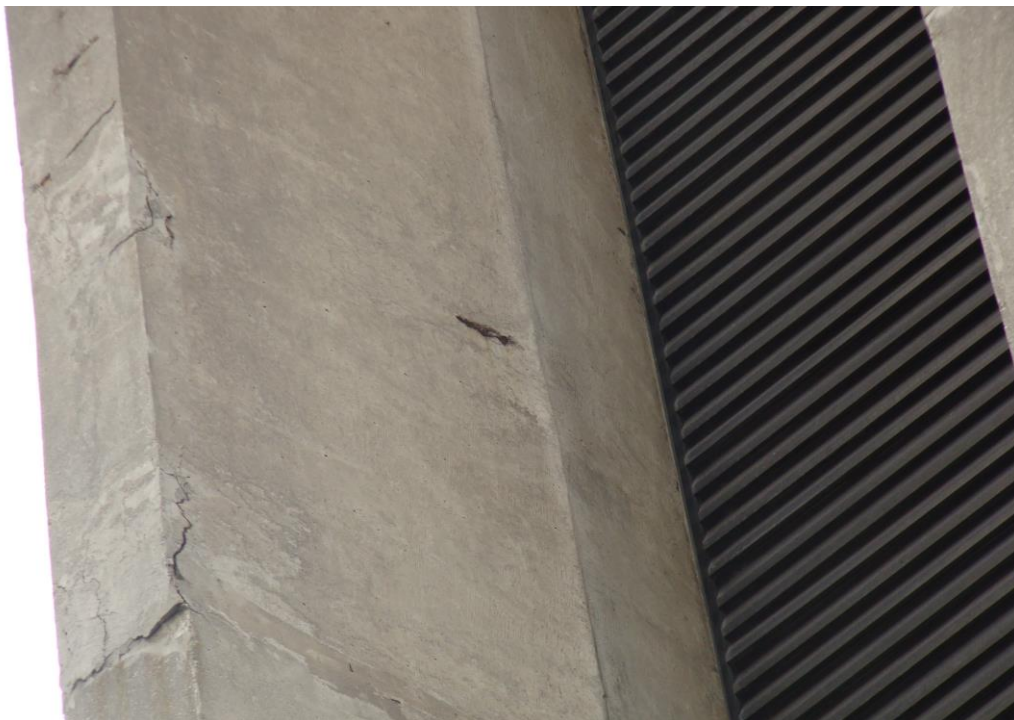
Armadura exposta pilar P11 (2º pavimento) (19/11/2013)
